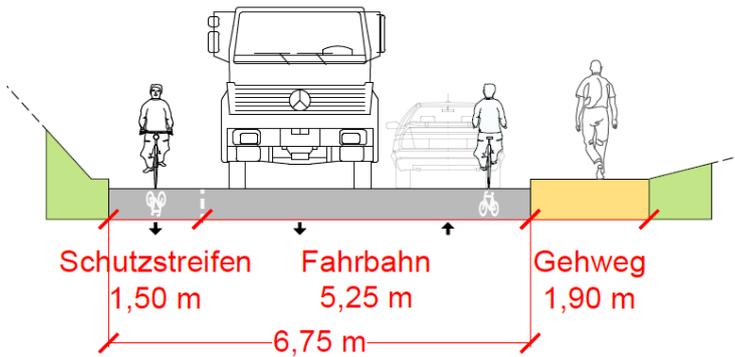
Querschnitt Friedlandstraße, Verortung: siehe Lageplan
